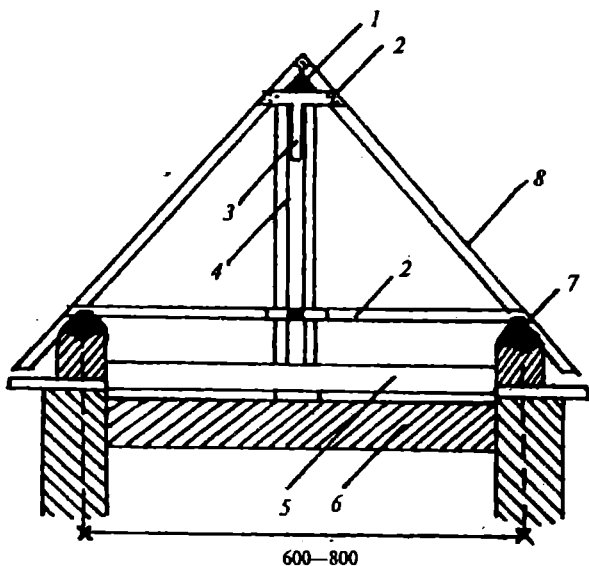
Наклонные стропила для двускатной крыши пролетом 6—8 м: 1 — коньковое стропило; 2 — крестовина; 3 — полосы; 4 — стойка; 5 — стропильная балка; 6 — конструкция перекрытия; 7 — кирпичная кладка; 8 — стропило; 9 — дубовый стержень; 10 — продольная связь; 11 — соединение
